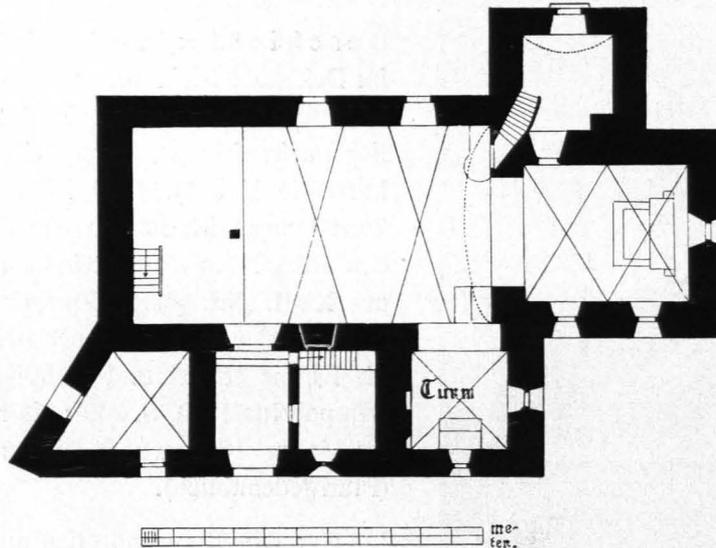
Brand, Pfarrkirche, Grundriß 1 : 250 (S. 299)
